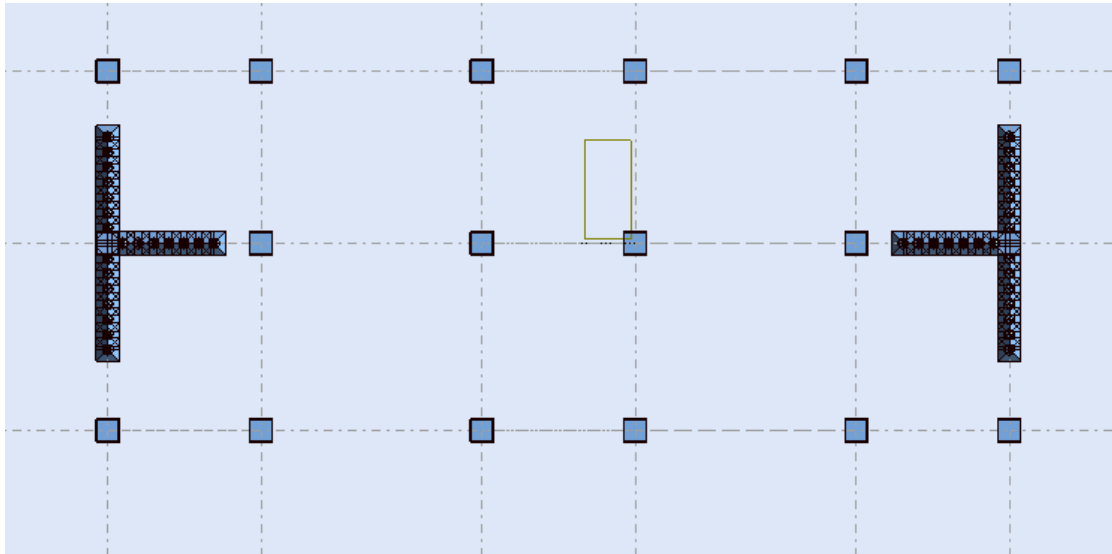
Vue en plan pour la disposition du voile selon le plan initial.
